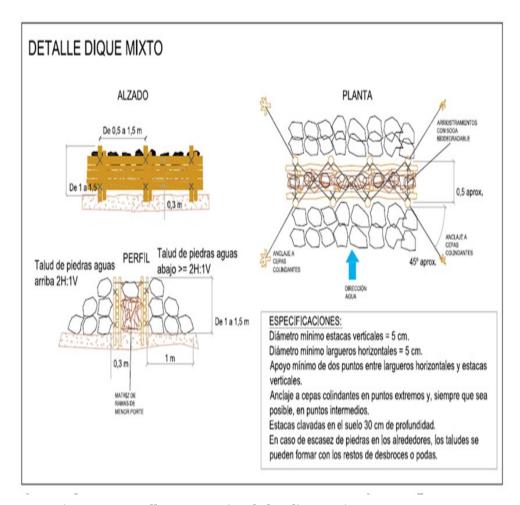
Detalle constructivo de los diques mixtos que se construyeron.
